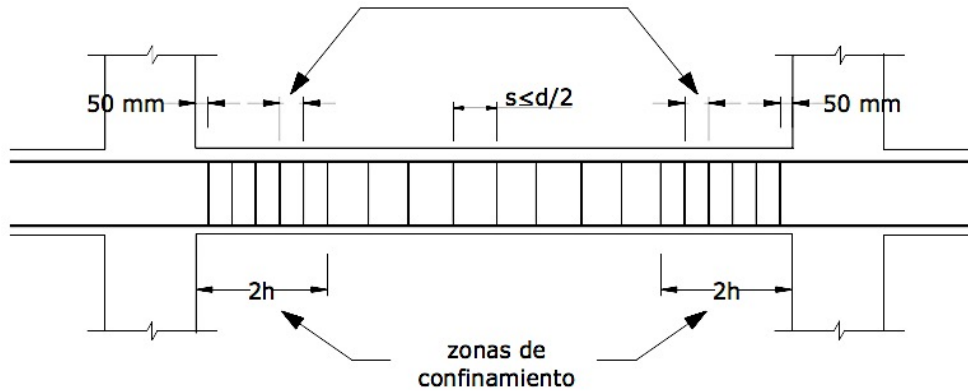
Separación de Estribos Fuente: “NEC_SE_HM 4.2.8b”
